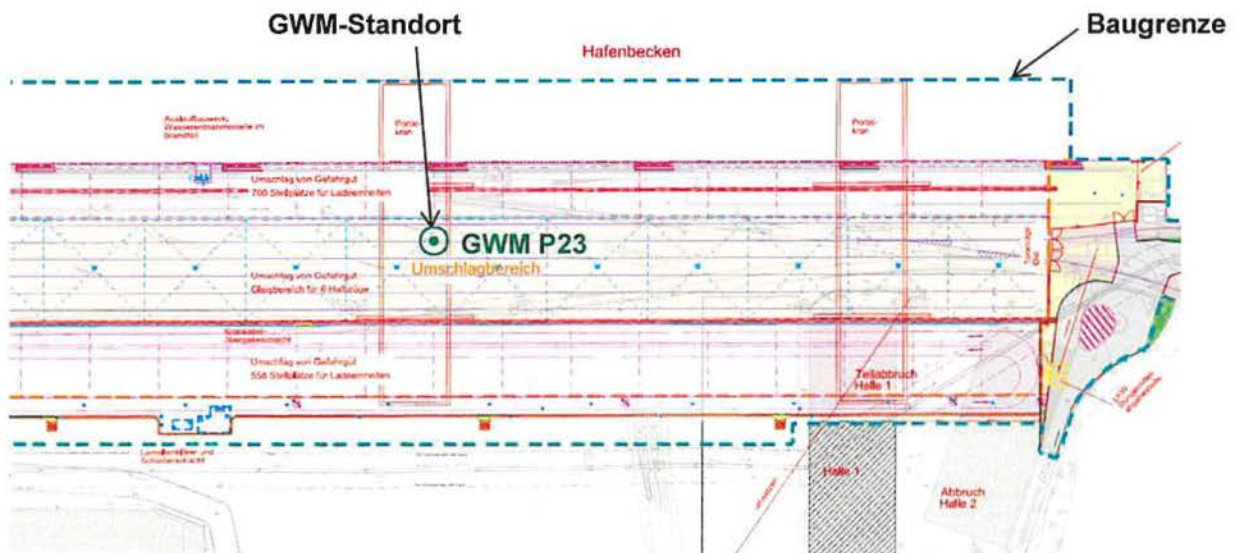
Ausschnitt Übersichtslageplan (duisport 05.05.2014) mit etwaigem Standort GWM P 23
